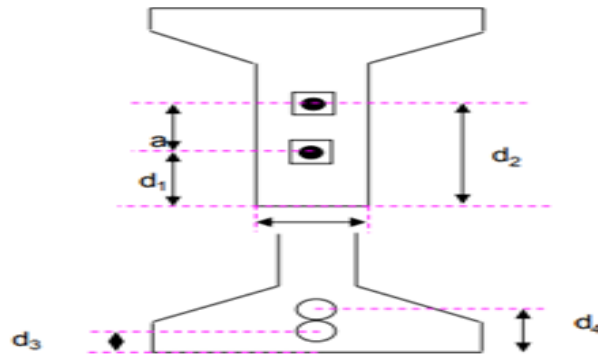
Disposition des câbles (Section d'about et Section à mi travée).
